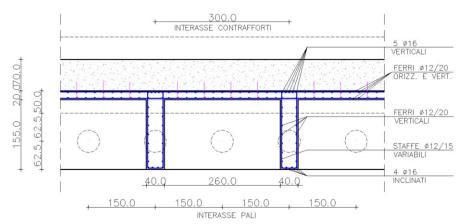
Estratto dell'elaborato 8, con la planimetria tipo dell'intervento di consolidamento
